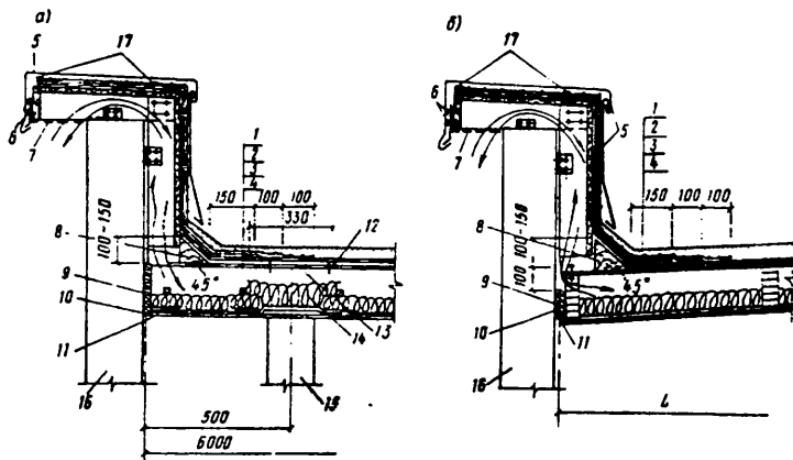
Устройство кровли покрытия из деревянных плит у парапетов:
